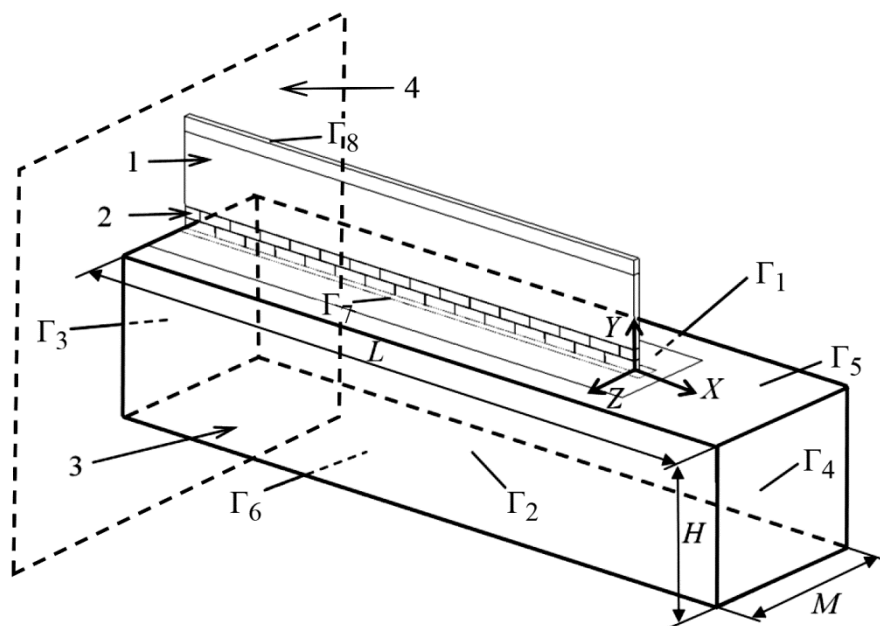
Расчетная схема для оценки НДС системы «кирпичное сооружение – ФБС – грунтовое основание» (1 – кирпичная стена; 2 – блоки ФБС; 3 – грунтовое основание; 4 – плоскость симметрии)
